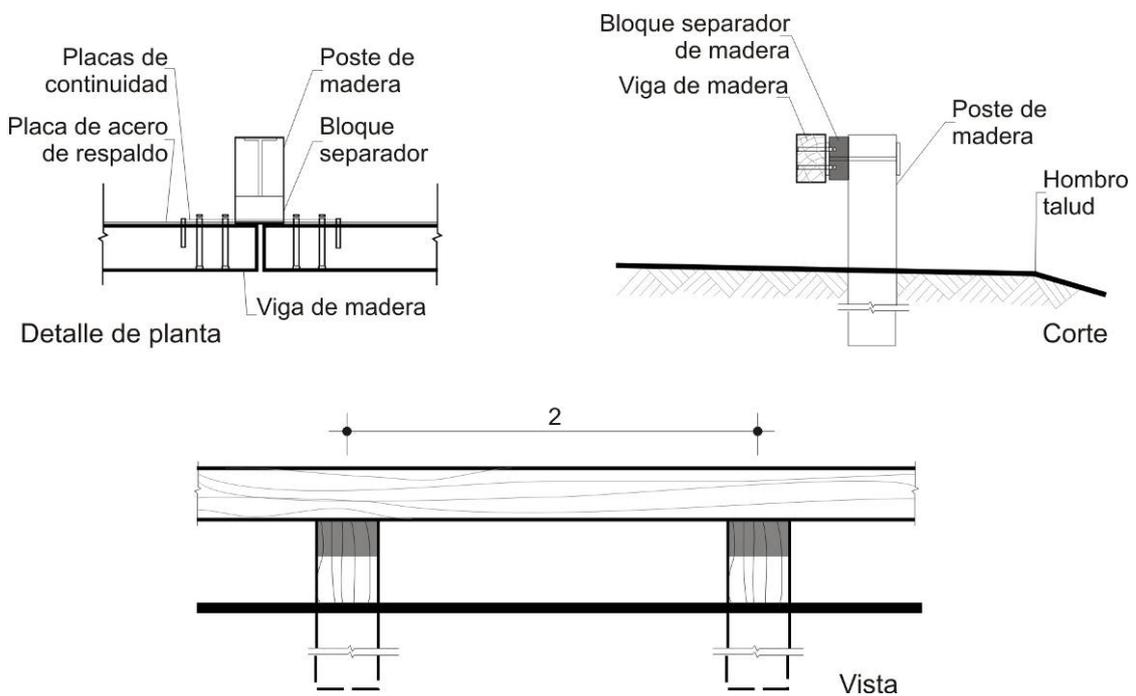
Sistema de viga rectangular con respaldo de placa metálica
